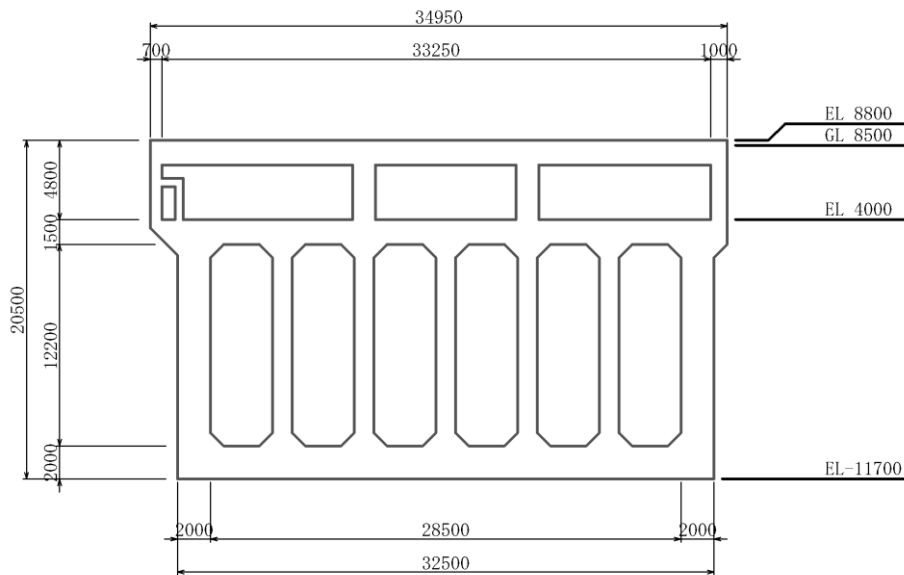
取水槽 断面図 (除じん機エリア (A-A断面))
